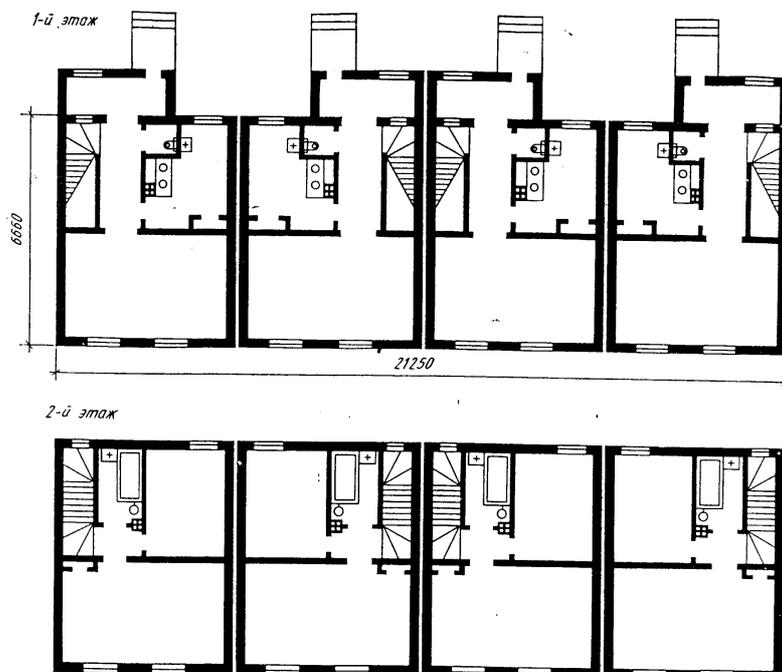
План здания из объёмных блоков размером на квартиру
